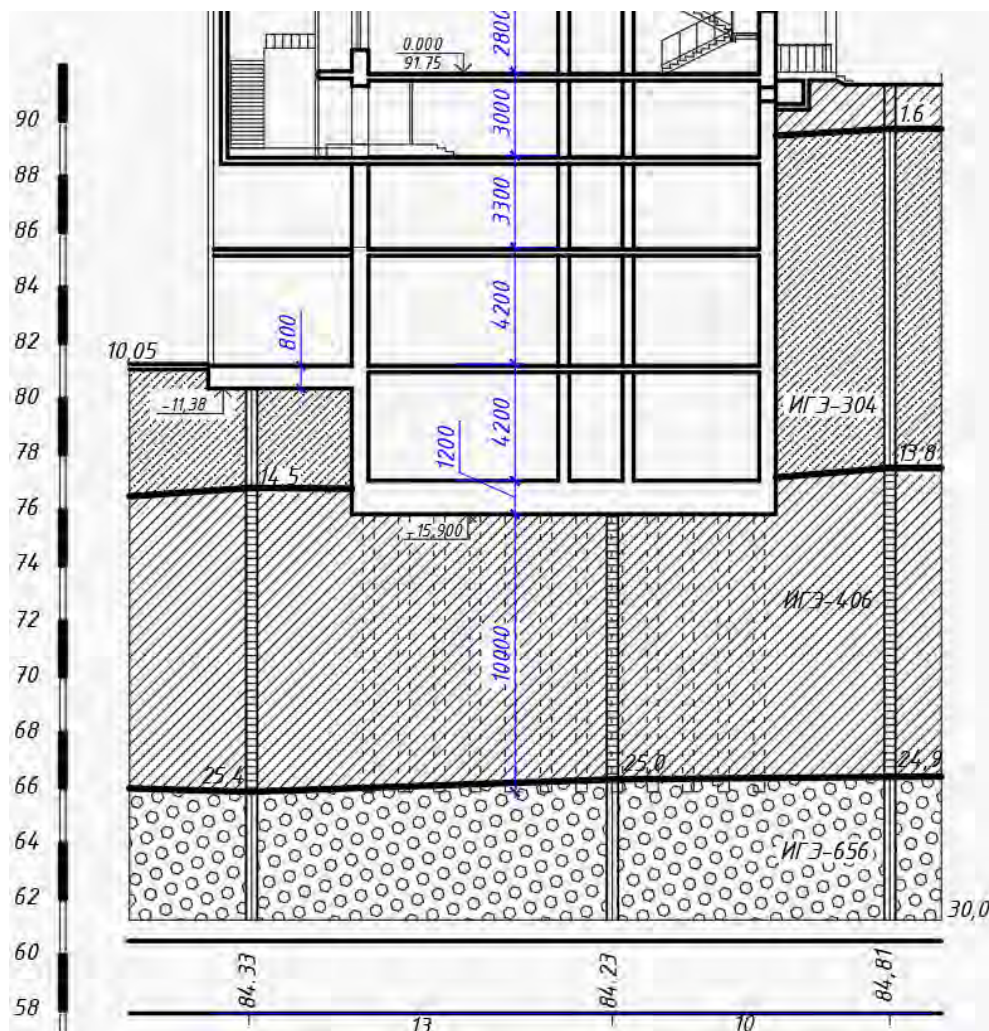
Инженерно-геологический разрез площадки здания с посадкой плитного и свайного (штрихпунктир) фундаментов
